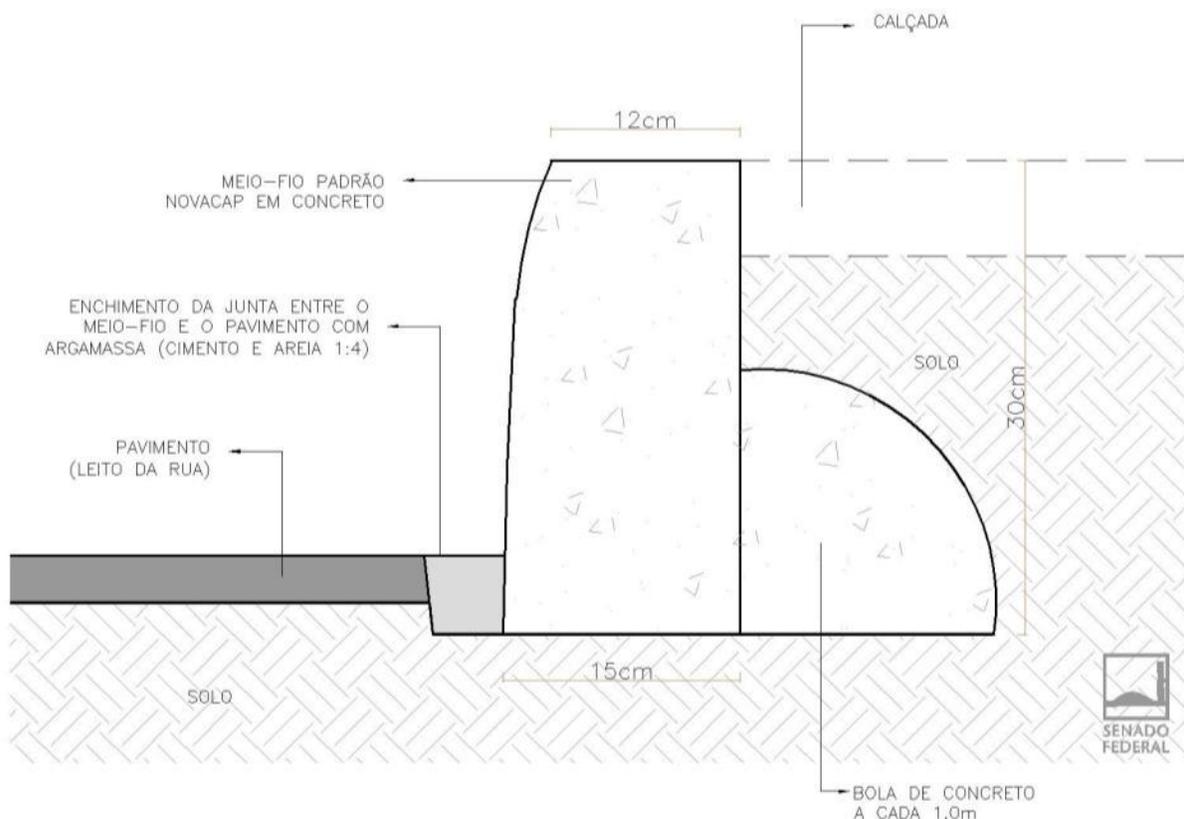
Detalhe esquemático da instalação de meio-fio.
